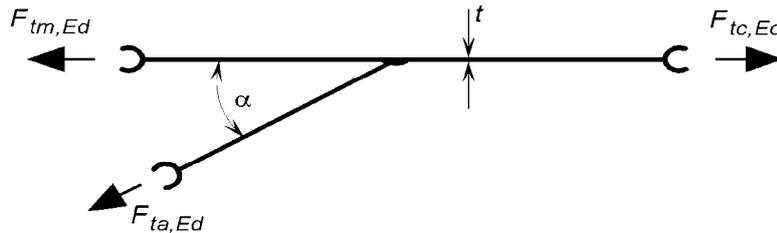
Geschweißte Verbindungsbohle
